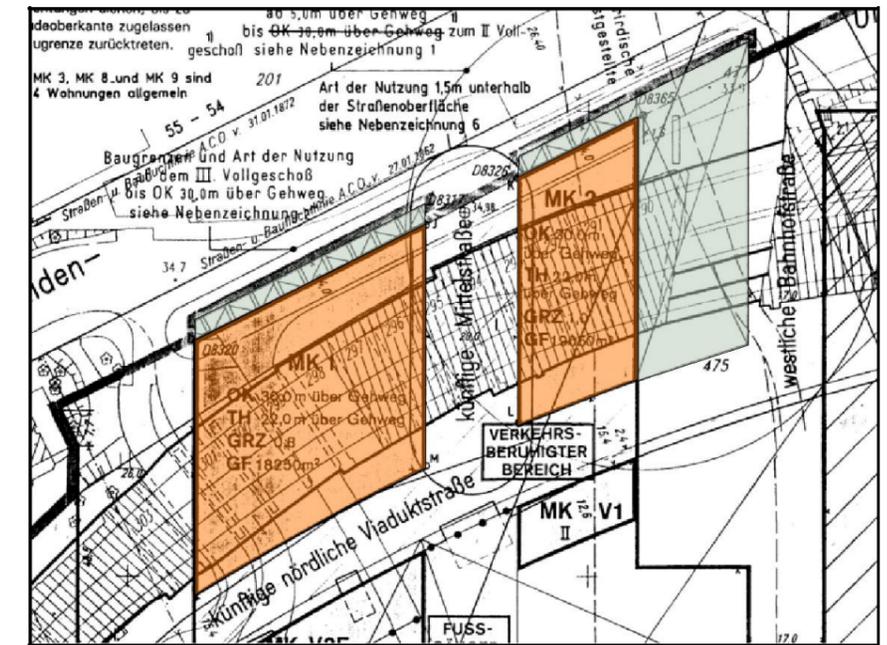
Bebauungsplanausschnitt M 1:1500
